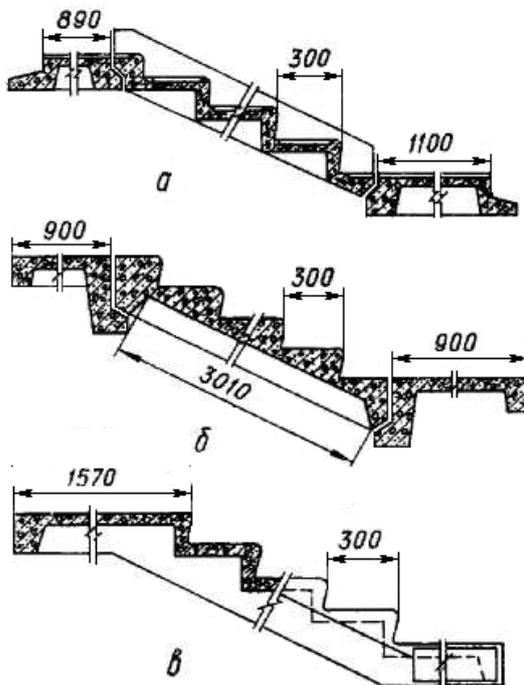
Крупноэлементные лестницы: а – лестничный марш складчатой конструкции с несущими ребрами; б – то же, ребристой конструкции; в – то же, со ступенями тонкостенной складчатой конструкции, совмещенной с полуплощадкой.
